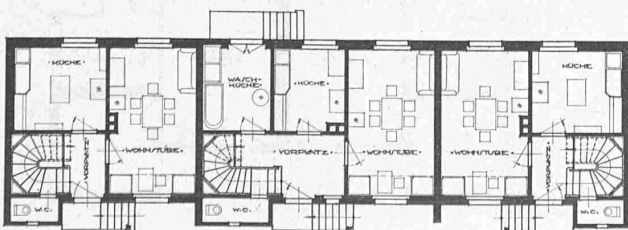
und 34 Grundrisse, Abb. 35 Rück-Passade. — Masstab 1:250.
